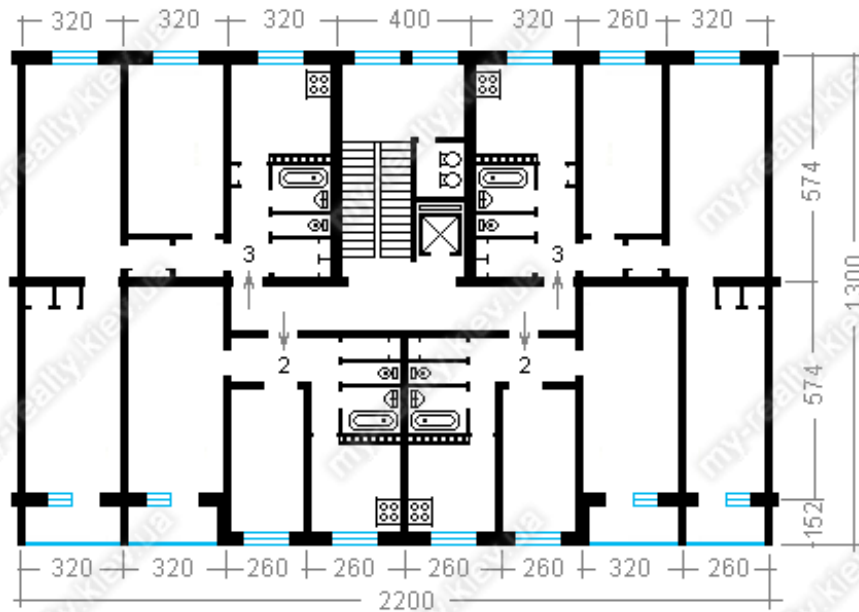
План типового поверху рядової секції 9-поверхового будинку. Проект 1-464
